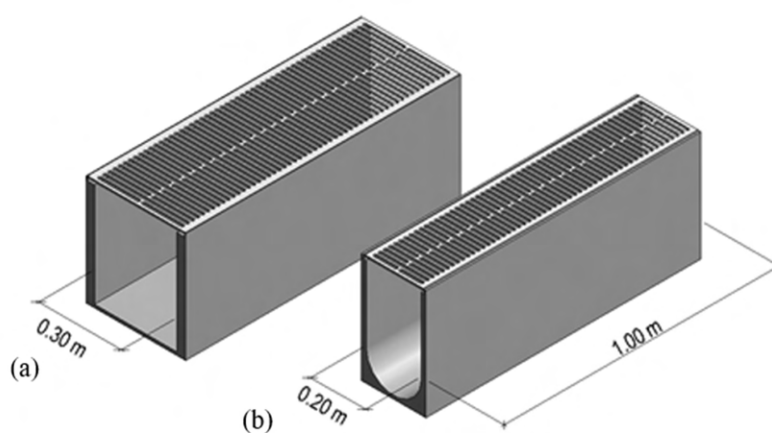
Dimensiones de los canales prefabricados para el drenaje superficial
